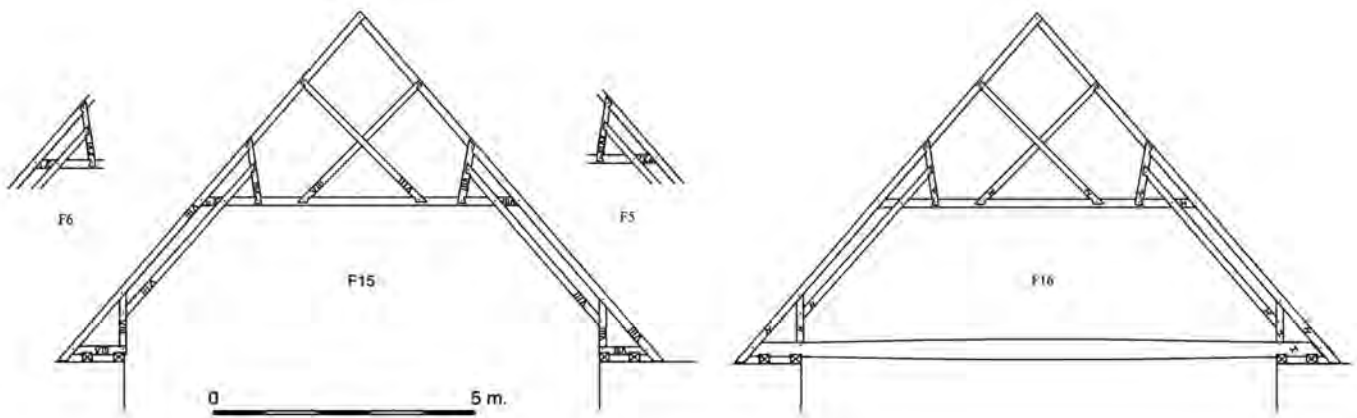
Fermes secondaire et principale du croisillon nord.
